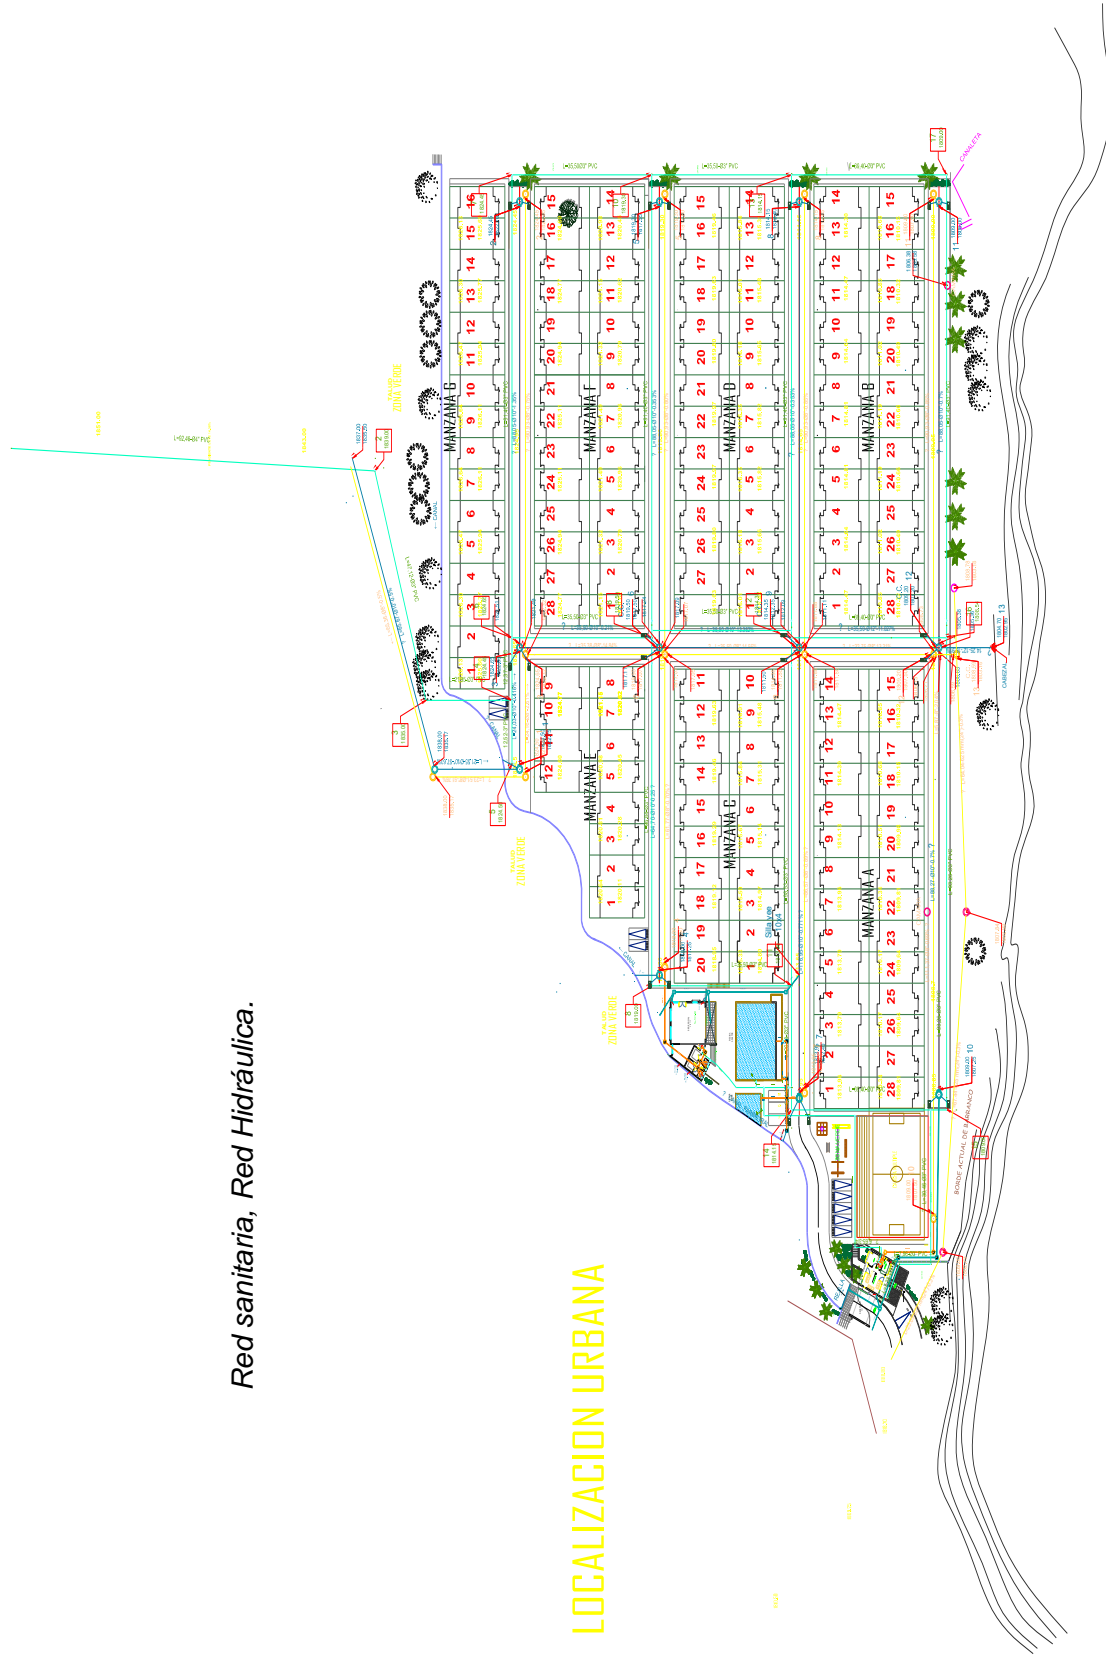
Fuente Diseño Planta Urbana, Ing. Henry Rivera Salcedo
